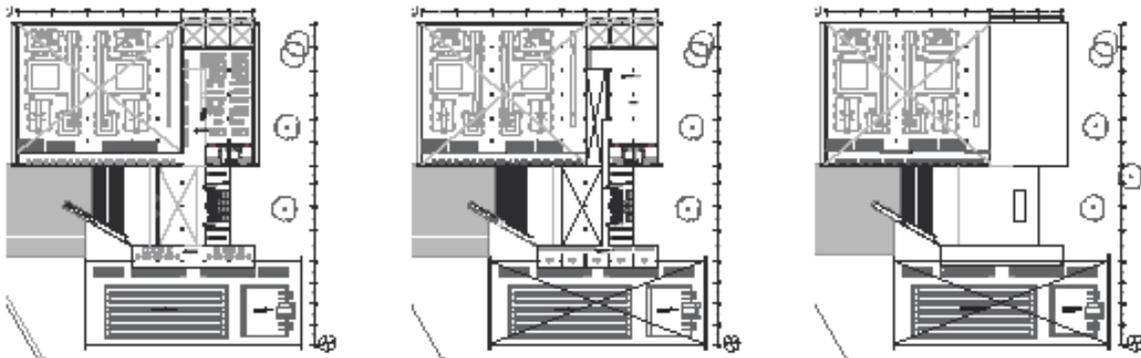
Planta Baja, Alta y Segunda respectivamente. – Gimnasia y Piscina Olímpica
